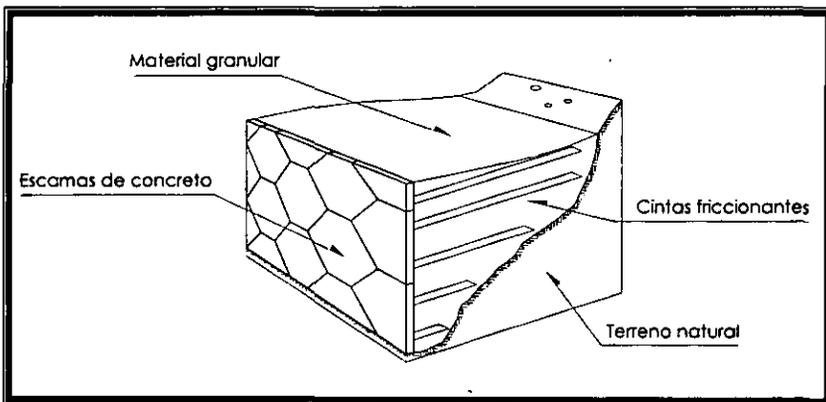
Elementos principales que forman el muro de tierra armada.
